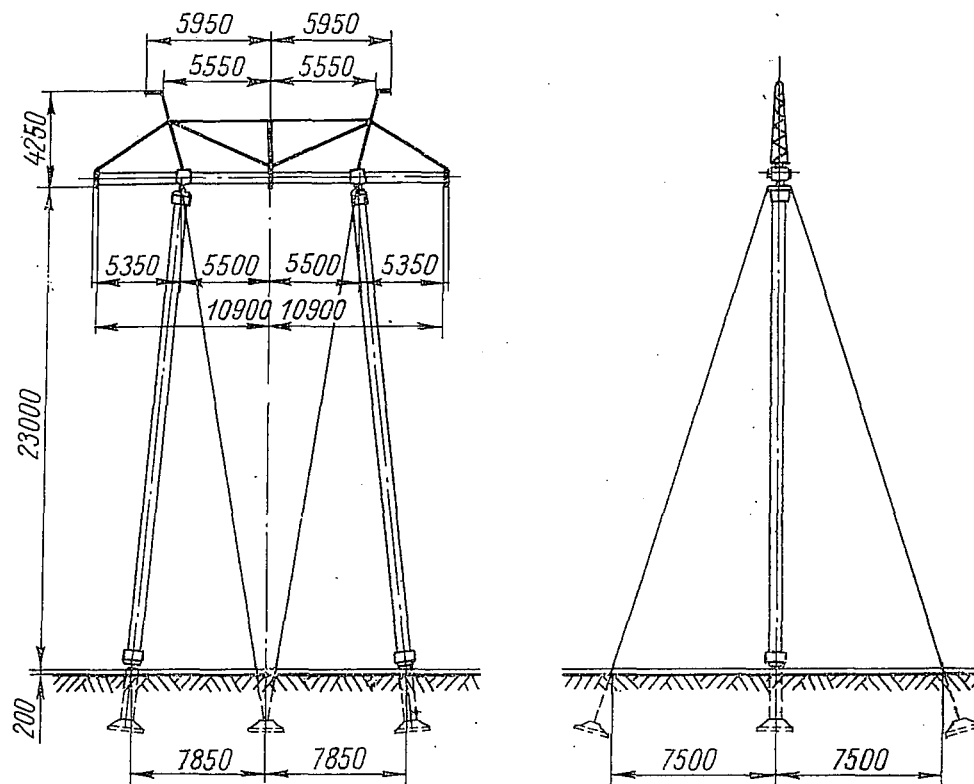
Промежуточная железобетонная опора ВЛ 500 кВ
